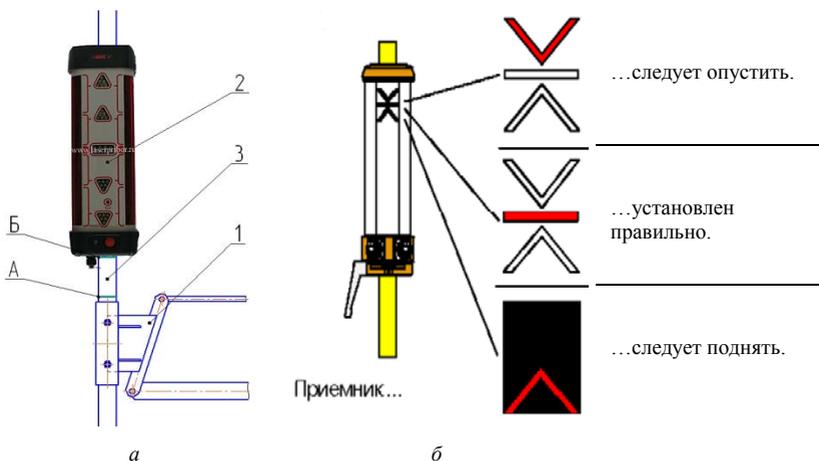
Установка приемника на компенсирующее устройство (а) и схема управления рабочим органом (б): 1 – кронштейн крепления штатива; 2 – приемник; 3 – штатив; А – метка установки штатива; Б – метка установки приемника
